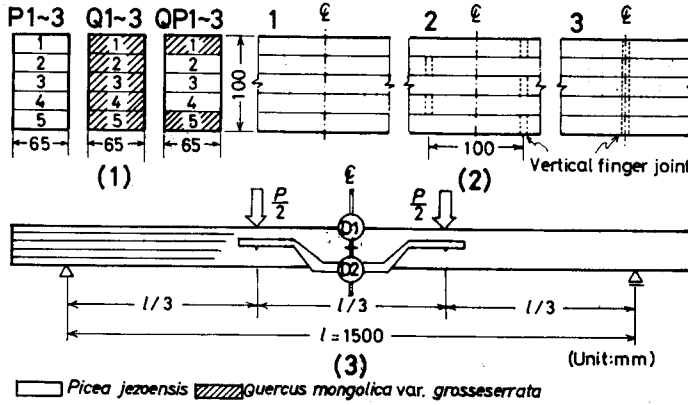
集成材の構成および試験方法 (1) 横断面 (2) フィンガージョイントの位置 (3) 試験方法, D1はスパン全長についての中央部たわみ測定用ダイヤルゲージ, D2は荷重点間用
